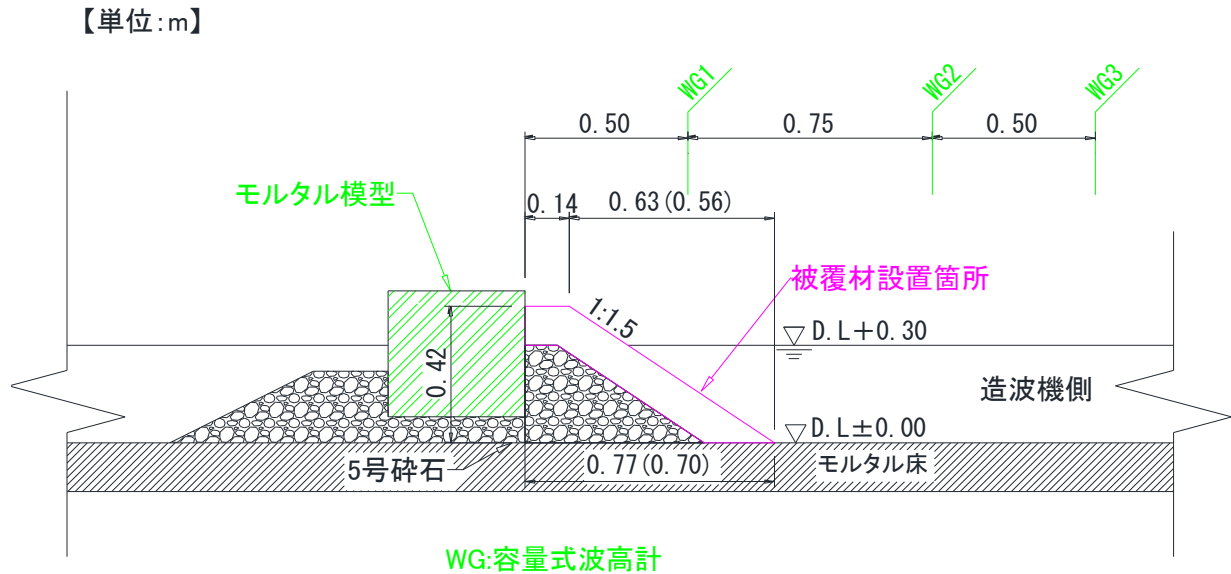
仮設被覆工の耐波安定性実験の断面図と計測機器設置位置図
